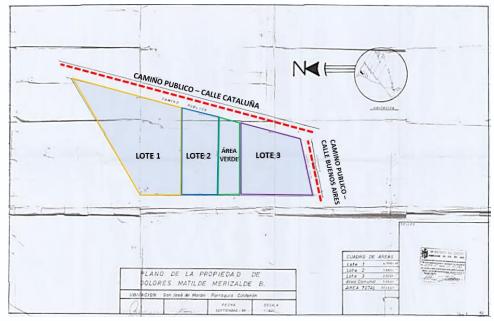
Plano de subdivisión 1983 Fuente: DMQ
